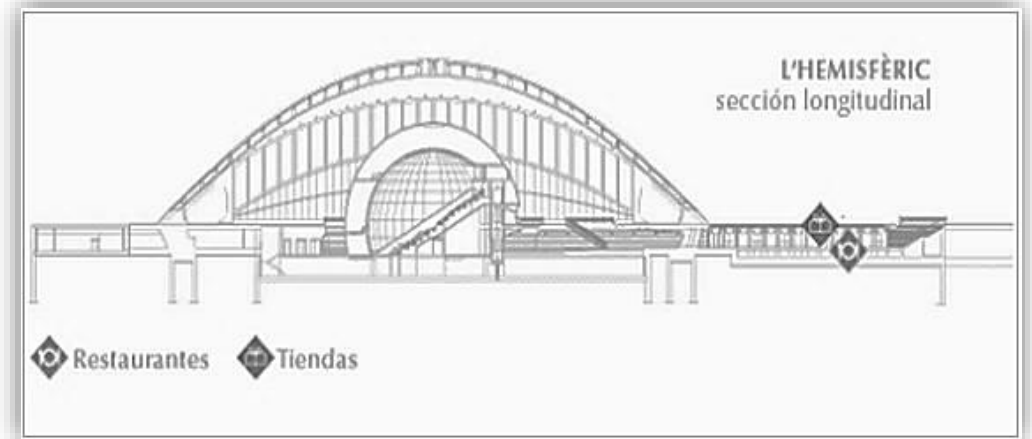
L'Hemisfèric. Corte Longitudinal del edificio.
